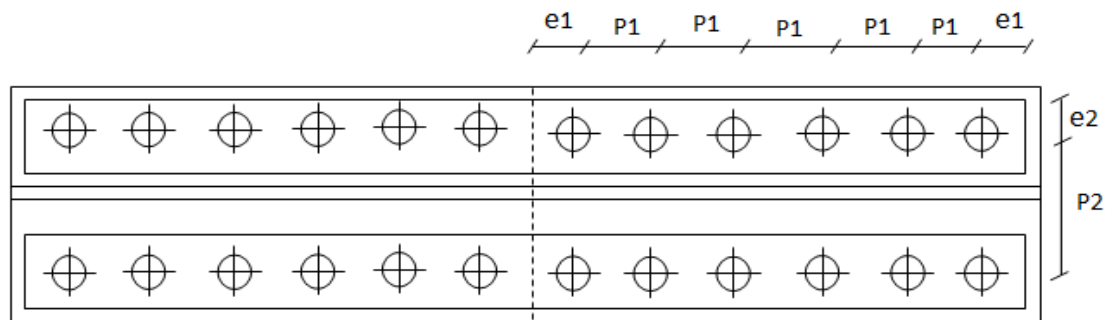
Disposition des boulons du couvre joint supérieur.
